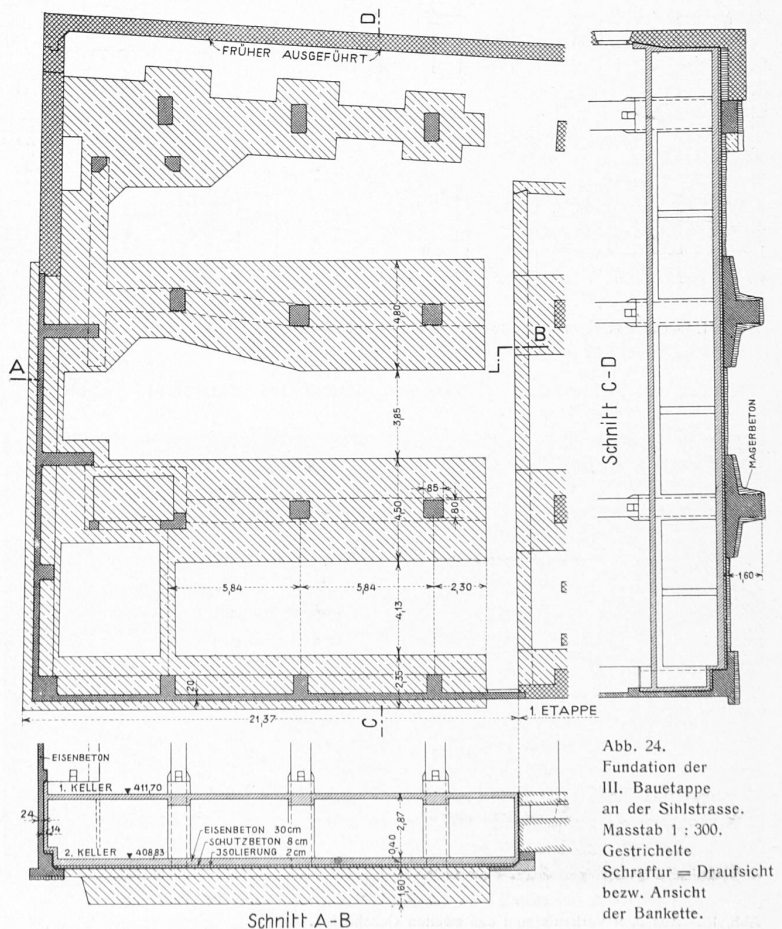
Fundation der III. Bauetappe an der Sihlstrasse. Masstab 1:300. Gestrichelte Schraffur = Draufsicht bezw. Ansicht der Bankette.
